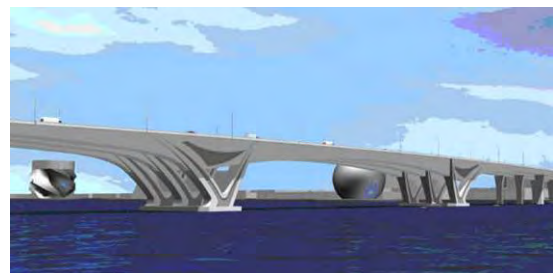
Darstellung der beiden Hauptpiers der geplanten Saadiyat Bridge
